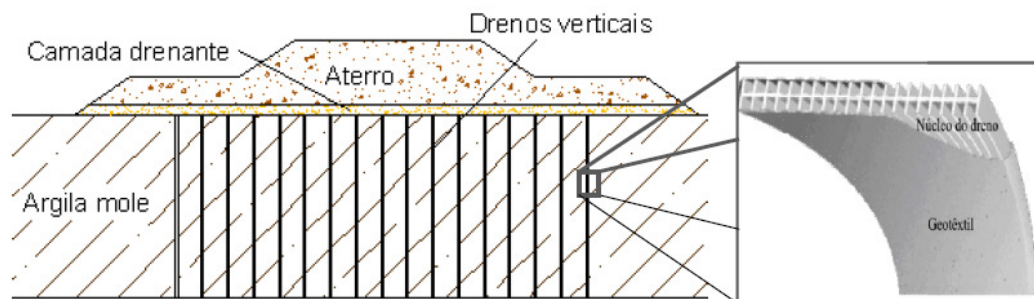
2: Esquema de um aterro com bermas de equilíbrio sobre drenos verticais.
